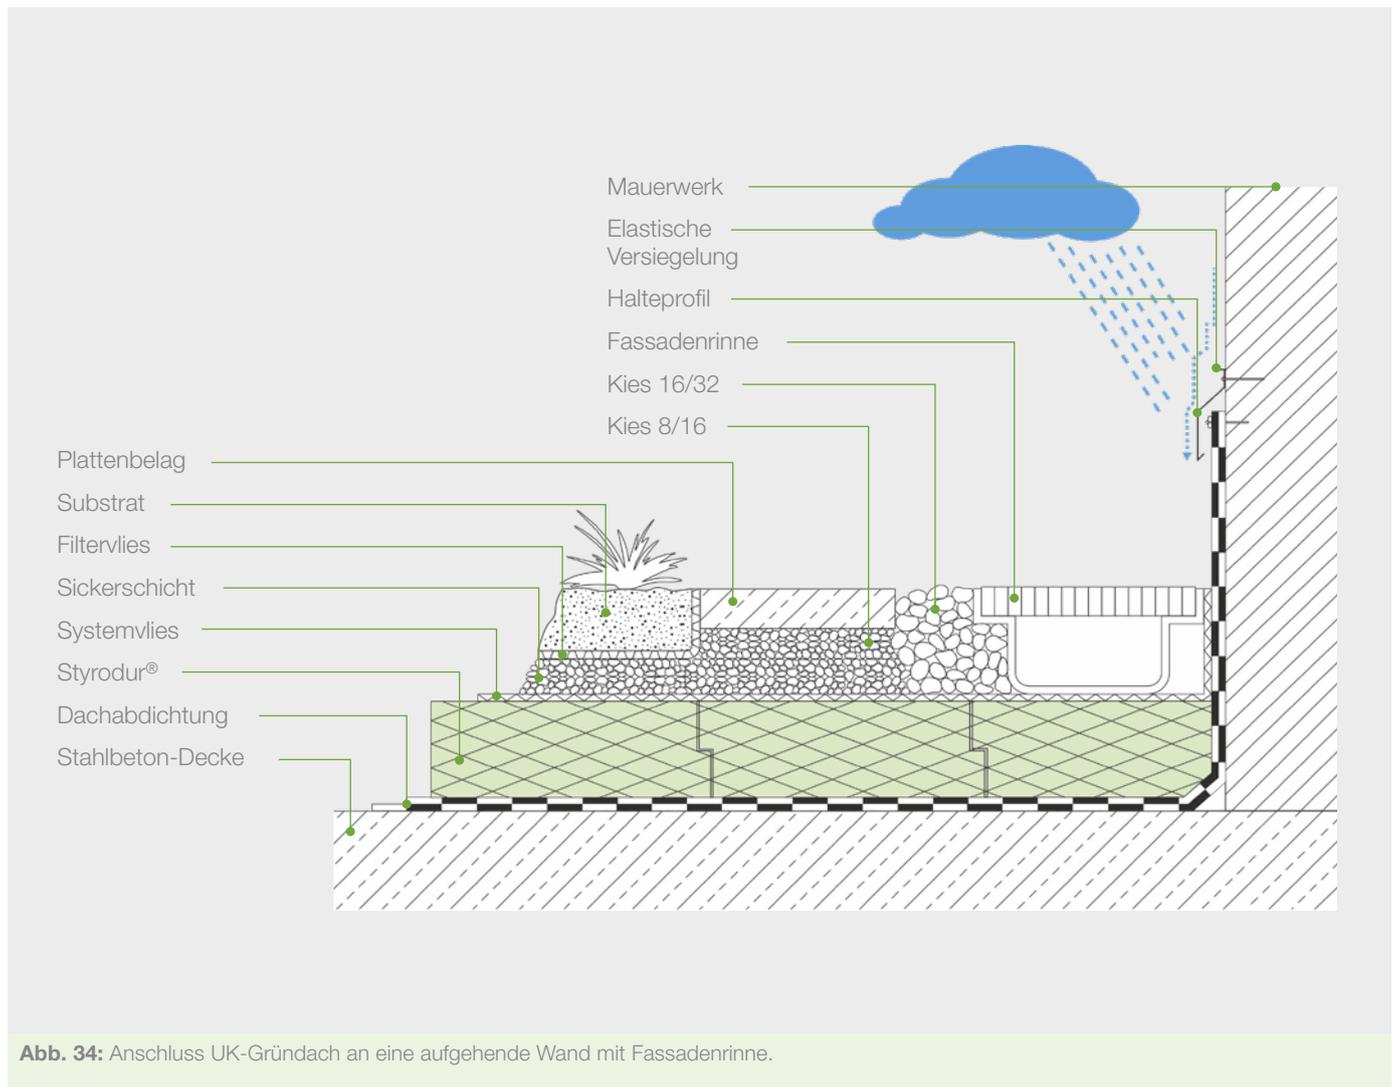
Anschluss UK-Gründach an eine aufgehende Wand mit Fassadenrinne.
